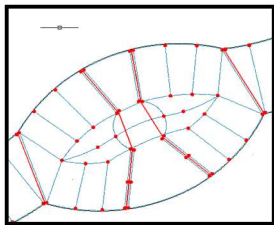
Plan de repérage de la structure en béton armé avec sa trame.
